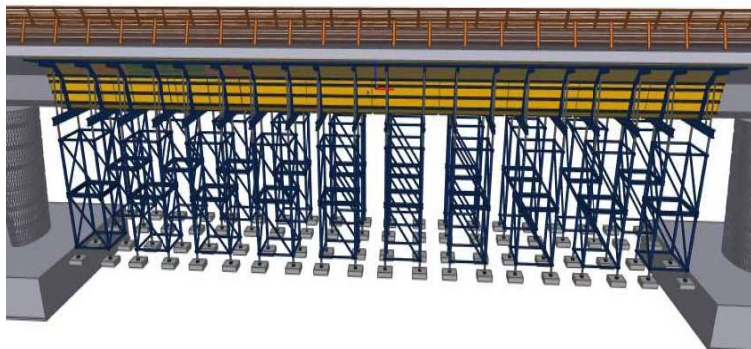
Proyecto piloto. Fuente: Propia (2024)
